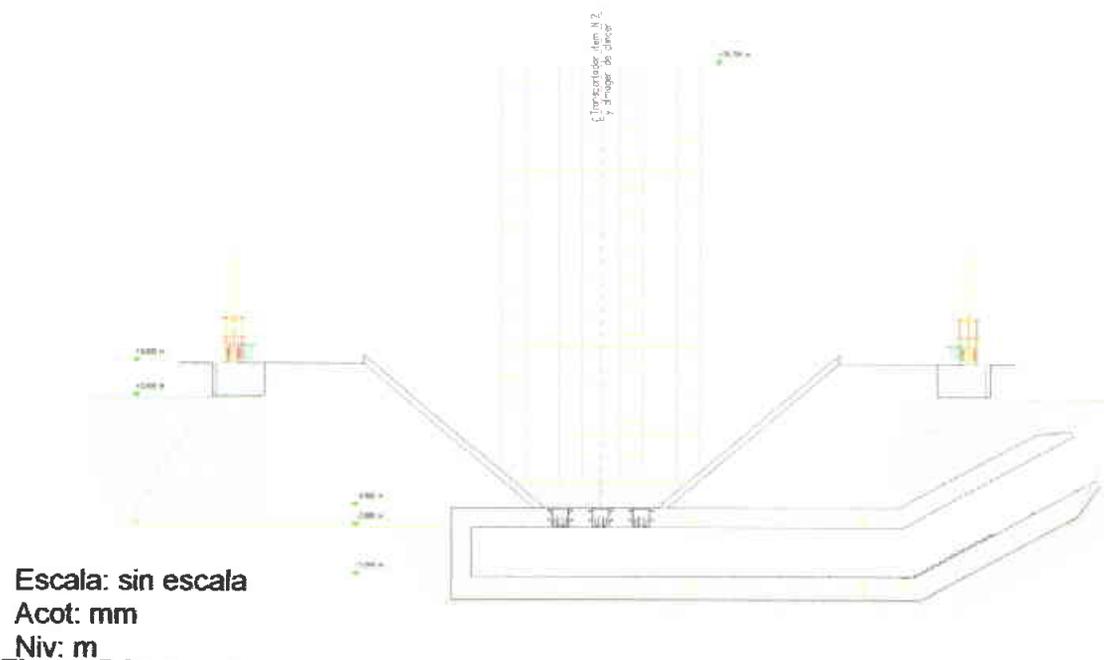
Detalle relleno p/colocación de obra falsa silo de clinker.
